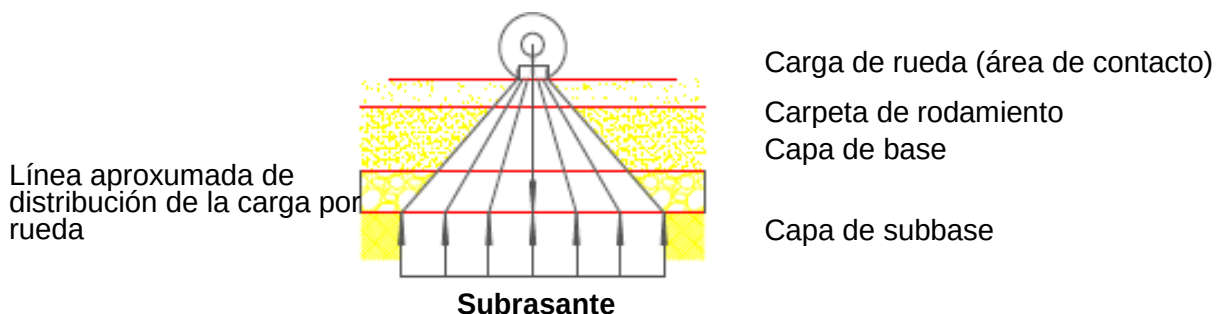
Distribución de carga de una rueda en el pavimento flexible
